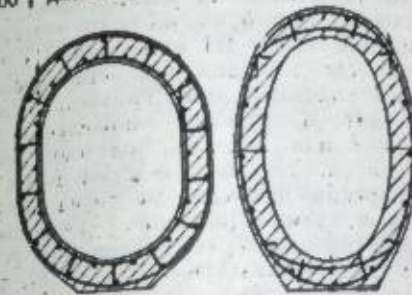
Дымовые боровы из сборного жаростойкого железобетона.
